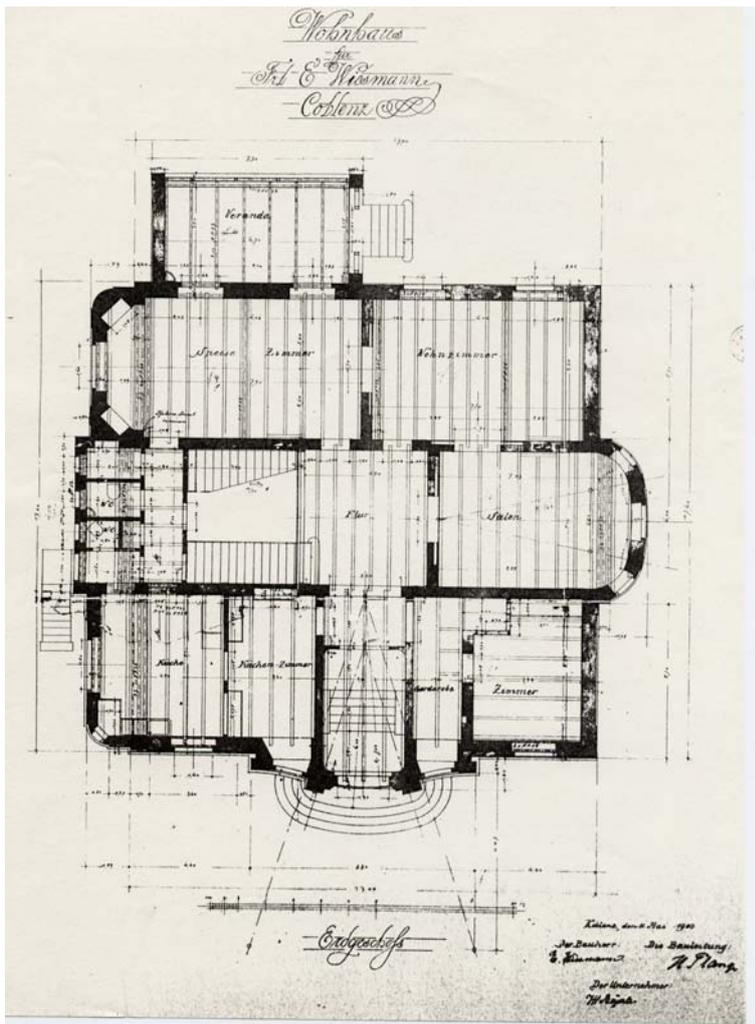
H. Plange, Villa Wiesmann, Grundriss Erdgeschoss
